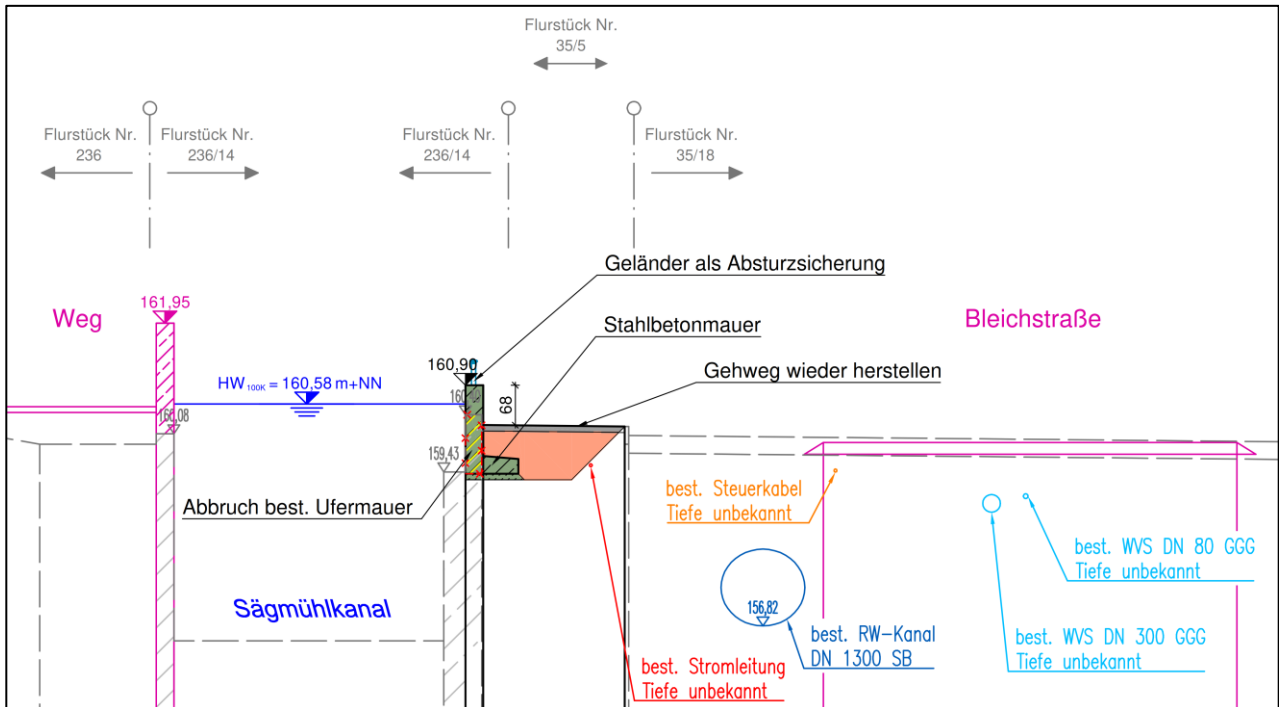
Schnitt 2, Erhöhung der Stahlbetonmauer
